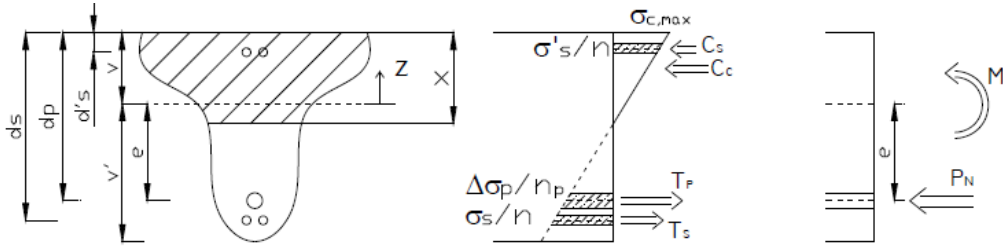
Equilibrio interno en una sección pretensada fisurada (Bairán G. & Marí B., 2011)
